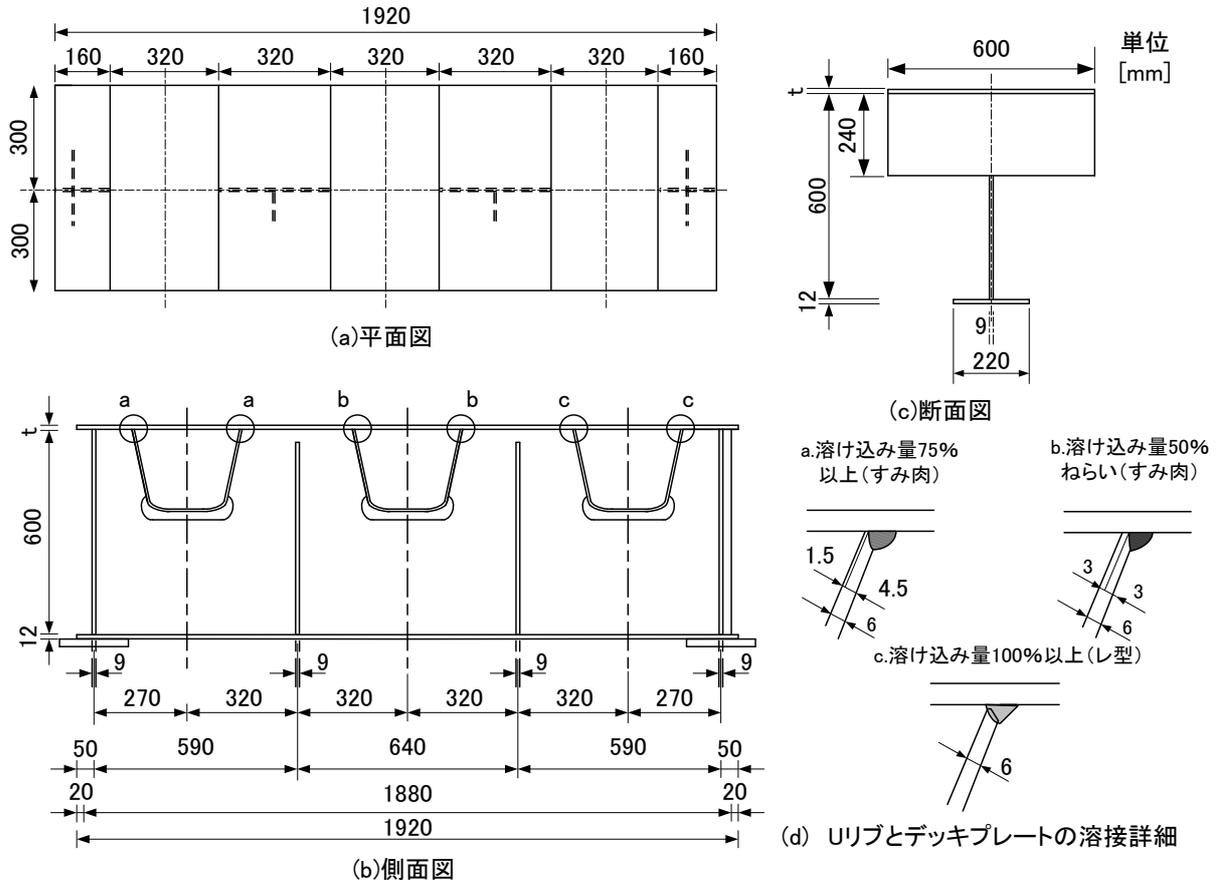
試験体の形状と寸法 (デッキプレート厚 t は 12mm または 16mm)
